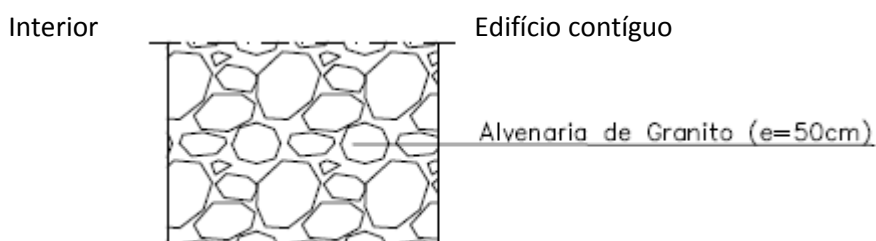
Pormenor construtivo das paredes Pi2 [19]
